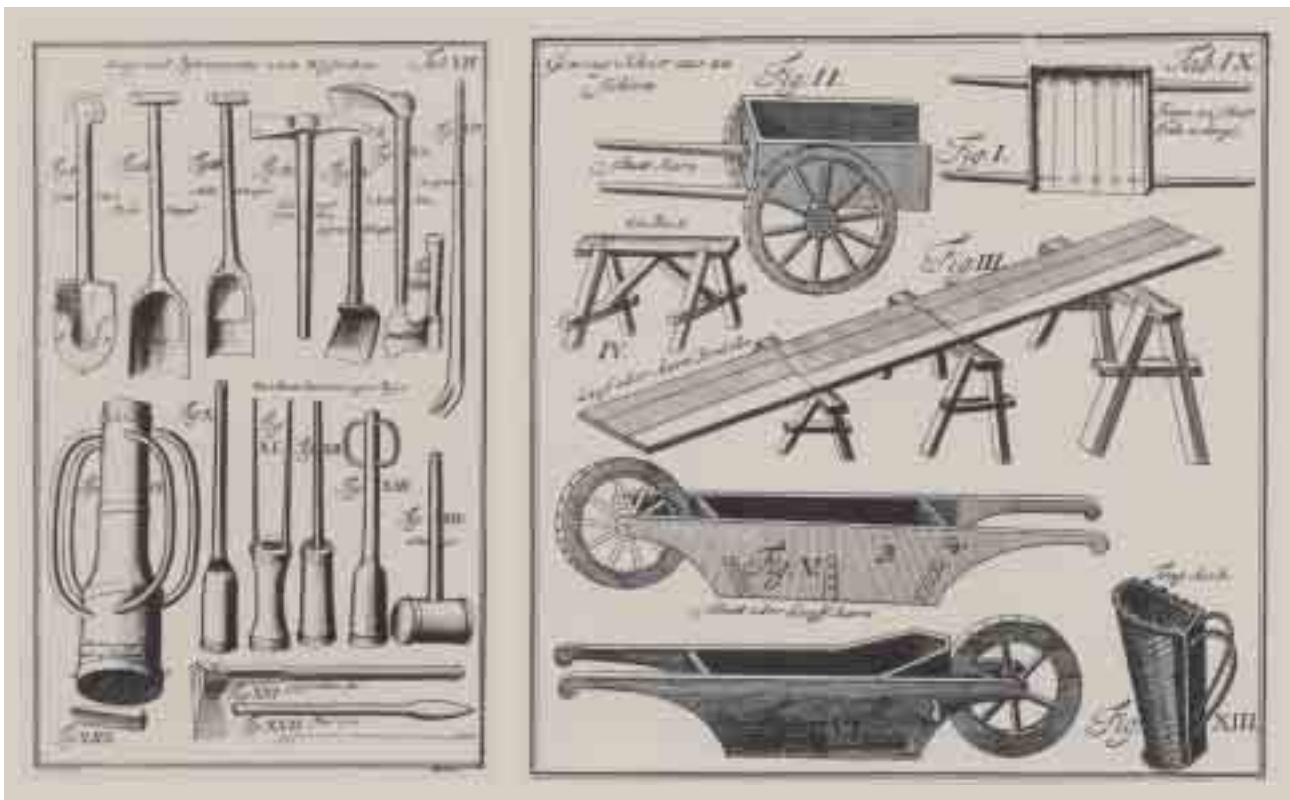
Geräte zur Auflockerung der Flusssohle. «Dem Sand locker zumachen das solchen das Wasser selbst fortführt.» Zeichnung nach J. Leupold, 1724.
